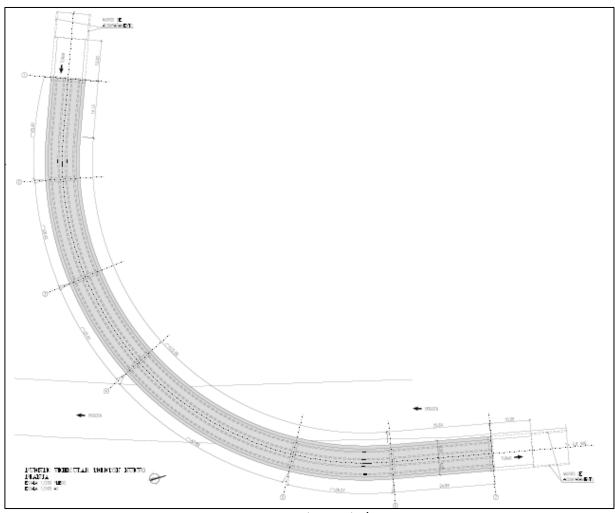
Vista en Planta Teletón Curvo Fuente: Planos levantamientos
